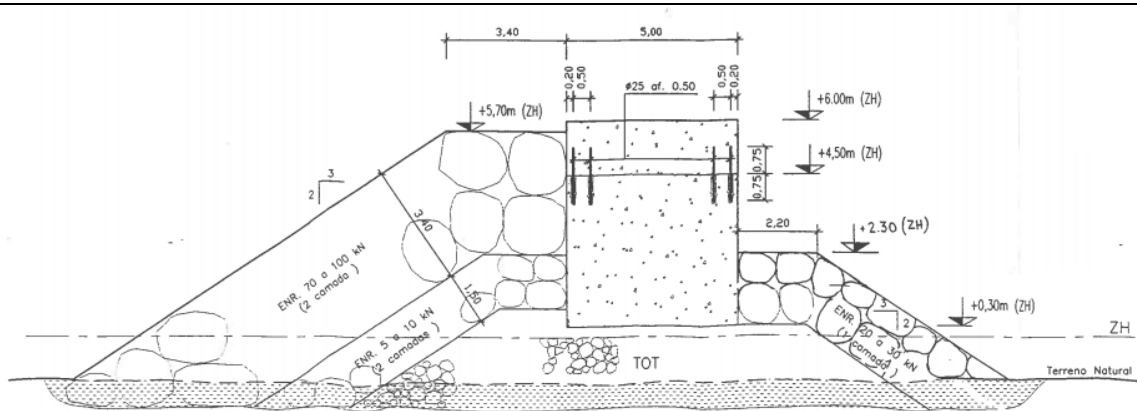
Perfil transversal tipo do quebramar destacado da Pedra Alta. [2]
